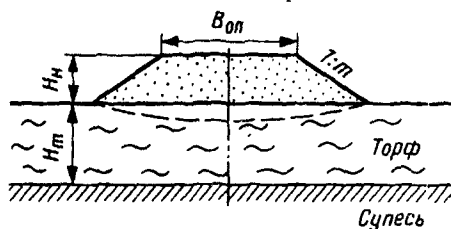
Расчетная схема для определения осадки насыпи на слабом основании
